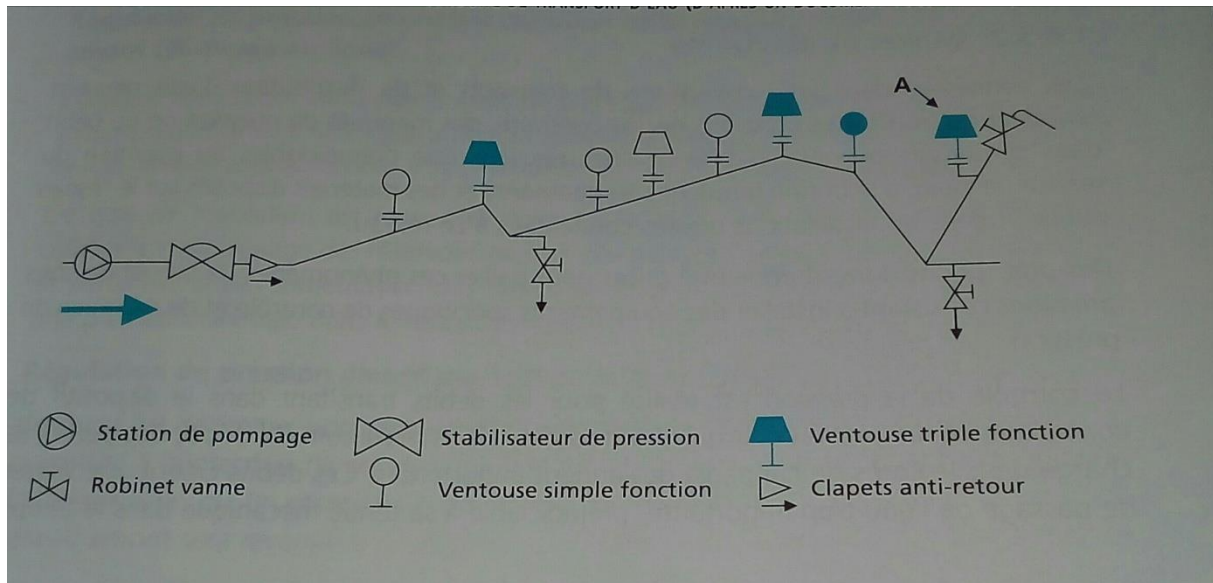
Profil en long d'une conduite d'adduction par refoulement.
